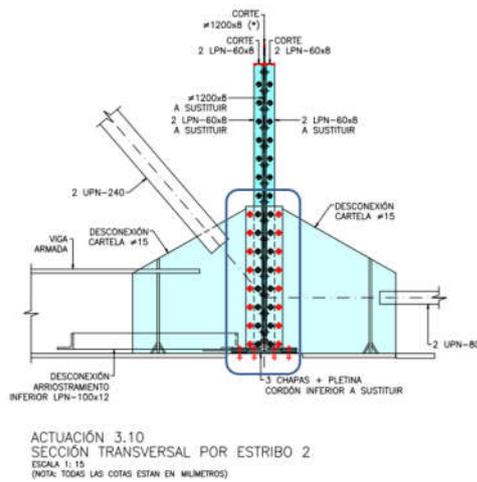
Nudo inferior mamparo de pila. Desatornillado de contraviento
